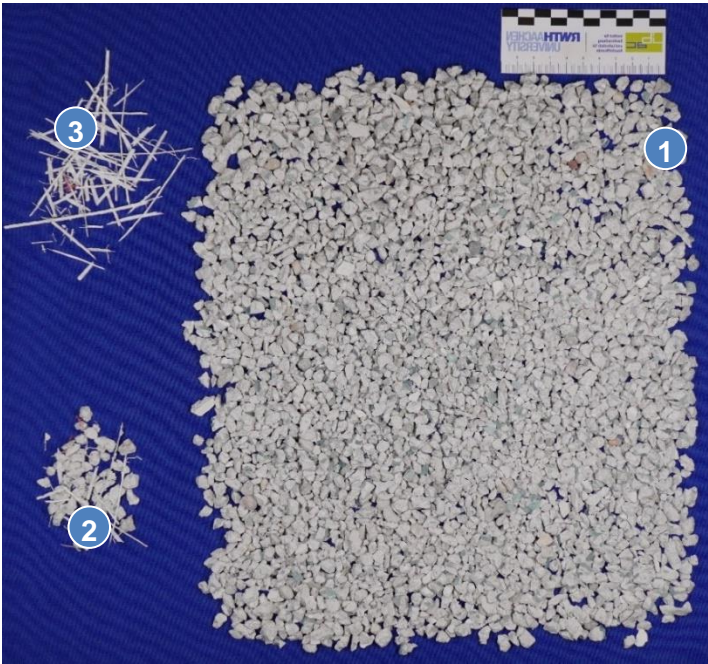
Bestandteile der untersuchten RC-GKG. > 4–8 mm 1. Betonbruch. 2. Betonbruch mit eingeschlossenen Faserresten. 3. Fasern
